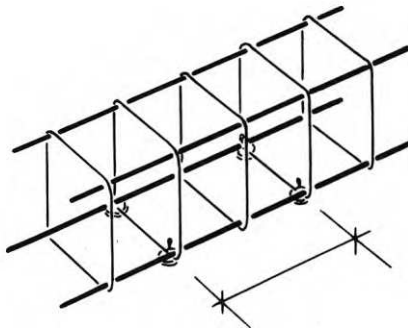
De mått mellan distansorganen, som bör underkastas bestämmelser för undvikande av alltför stora deformationer hos balkarmeringen.
